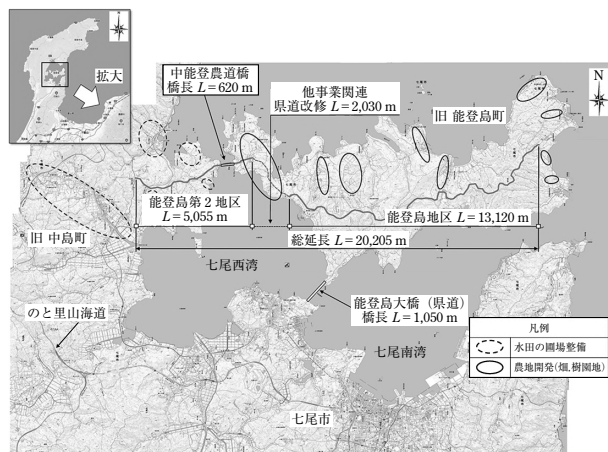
広域営農団地農道整備事業「能登島」地区一般平面図
